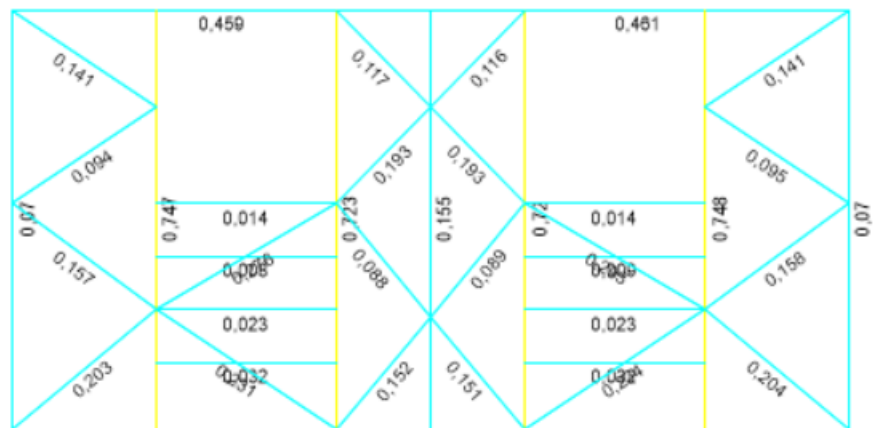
Factores de utilización vista en planta elevación 12.3 m.
